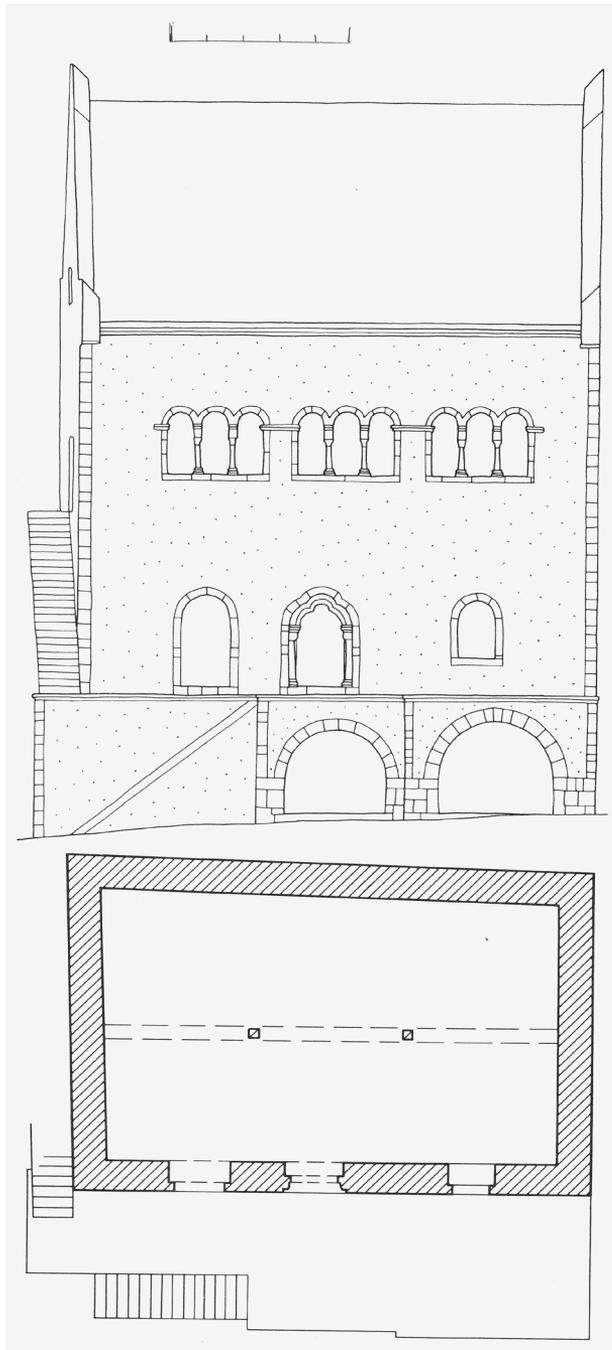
Rekonstruktion von Fassaden und Grundriss durch Anita WIEDENAU [aus: WIEDENAU: Katalog (wie Anm. 194)]
